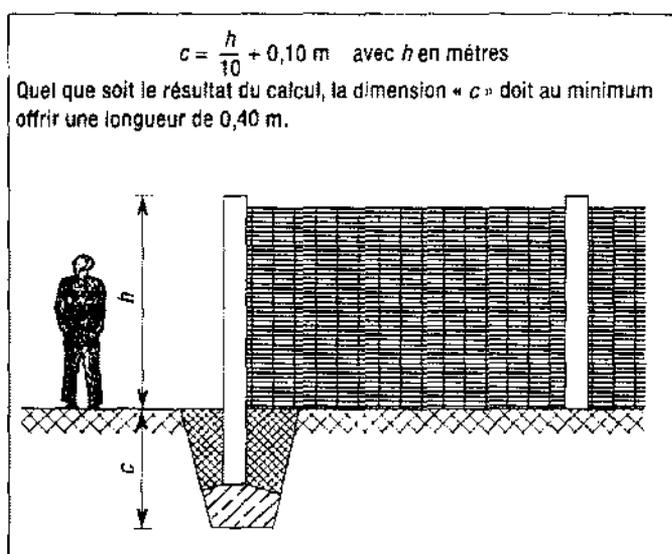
Stabilité d'une clôture de chantier (étanche au vent).
